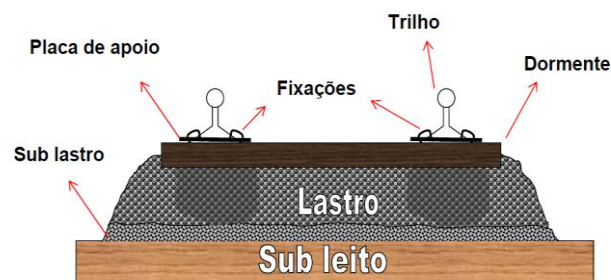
Componentes da estrutura da grade ferroviária (FONTE - AAR, 2010 - adaptado)
